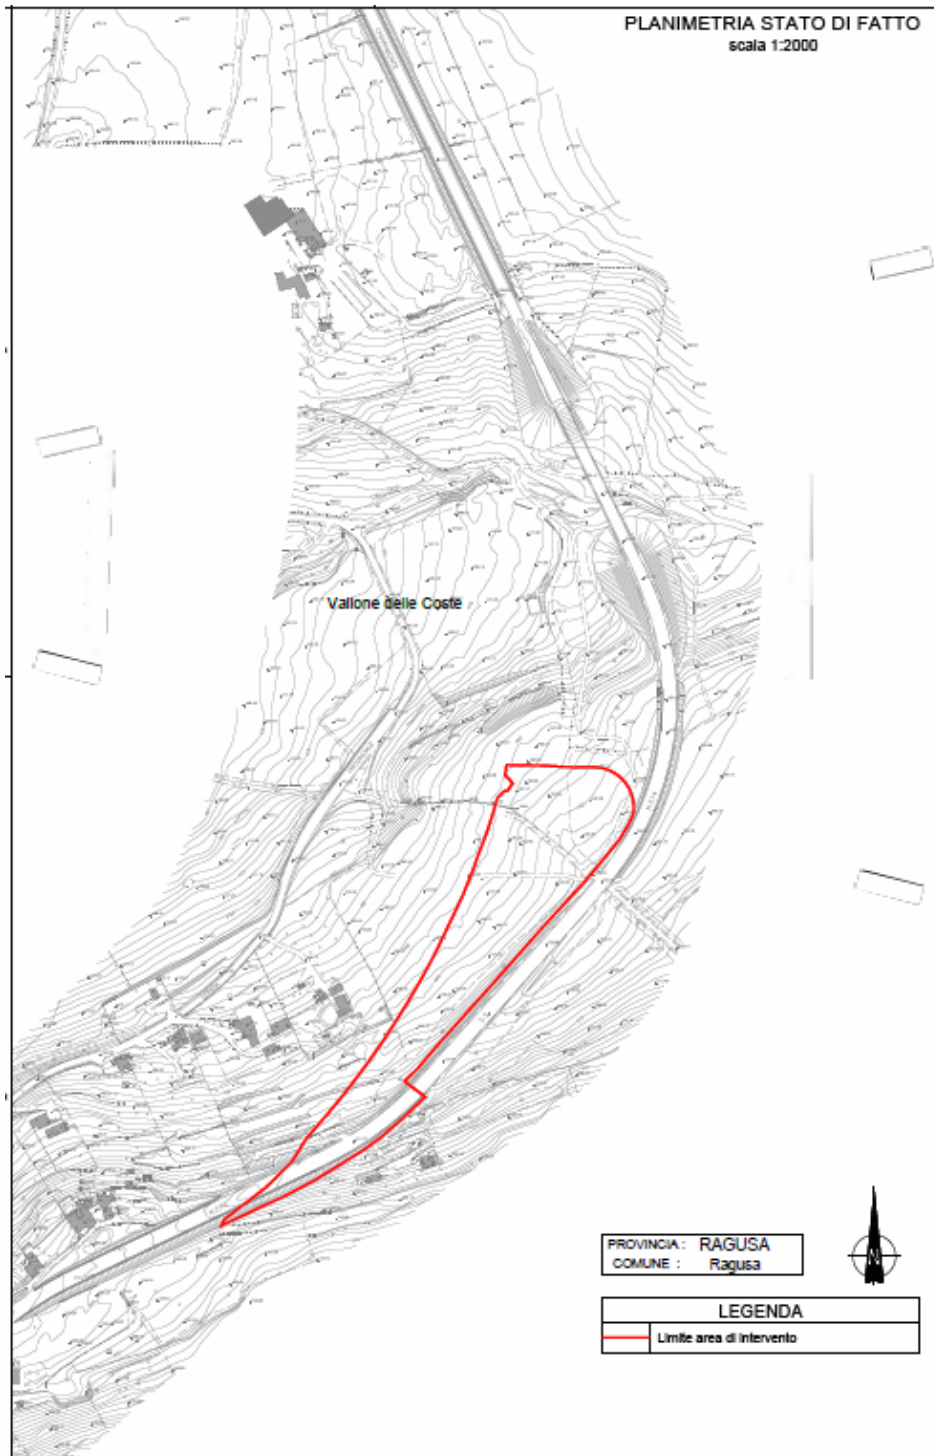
stralcio planimetrico dell'area di intervento di rimodellamento e rinaturalizzazione
